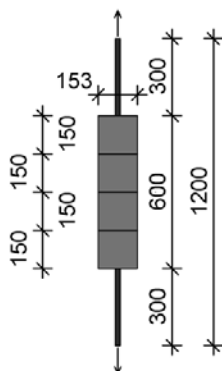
Geometrie Dehnkörper Typ 1 (Maße in mm)
